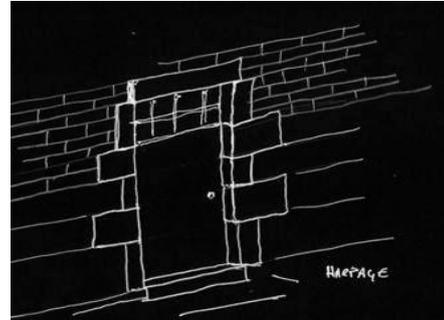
détail d'encadrement en pierre moellon (source : construction en maçonnerie)
